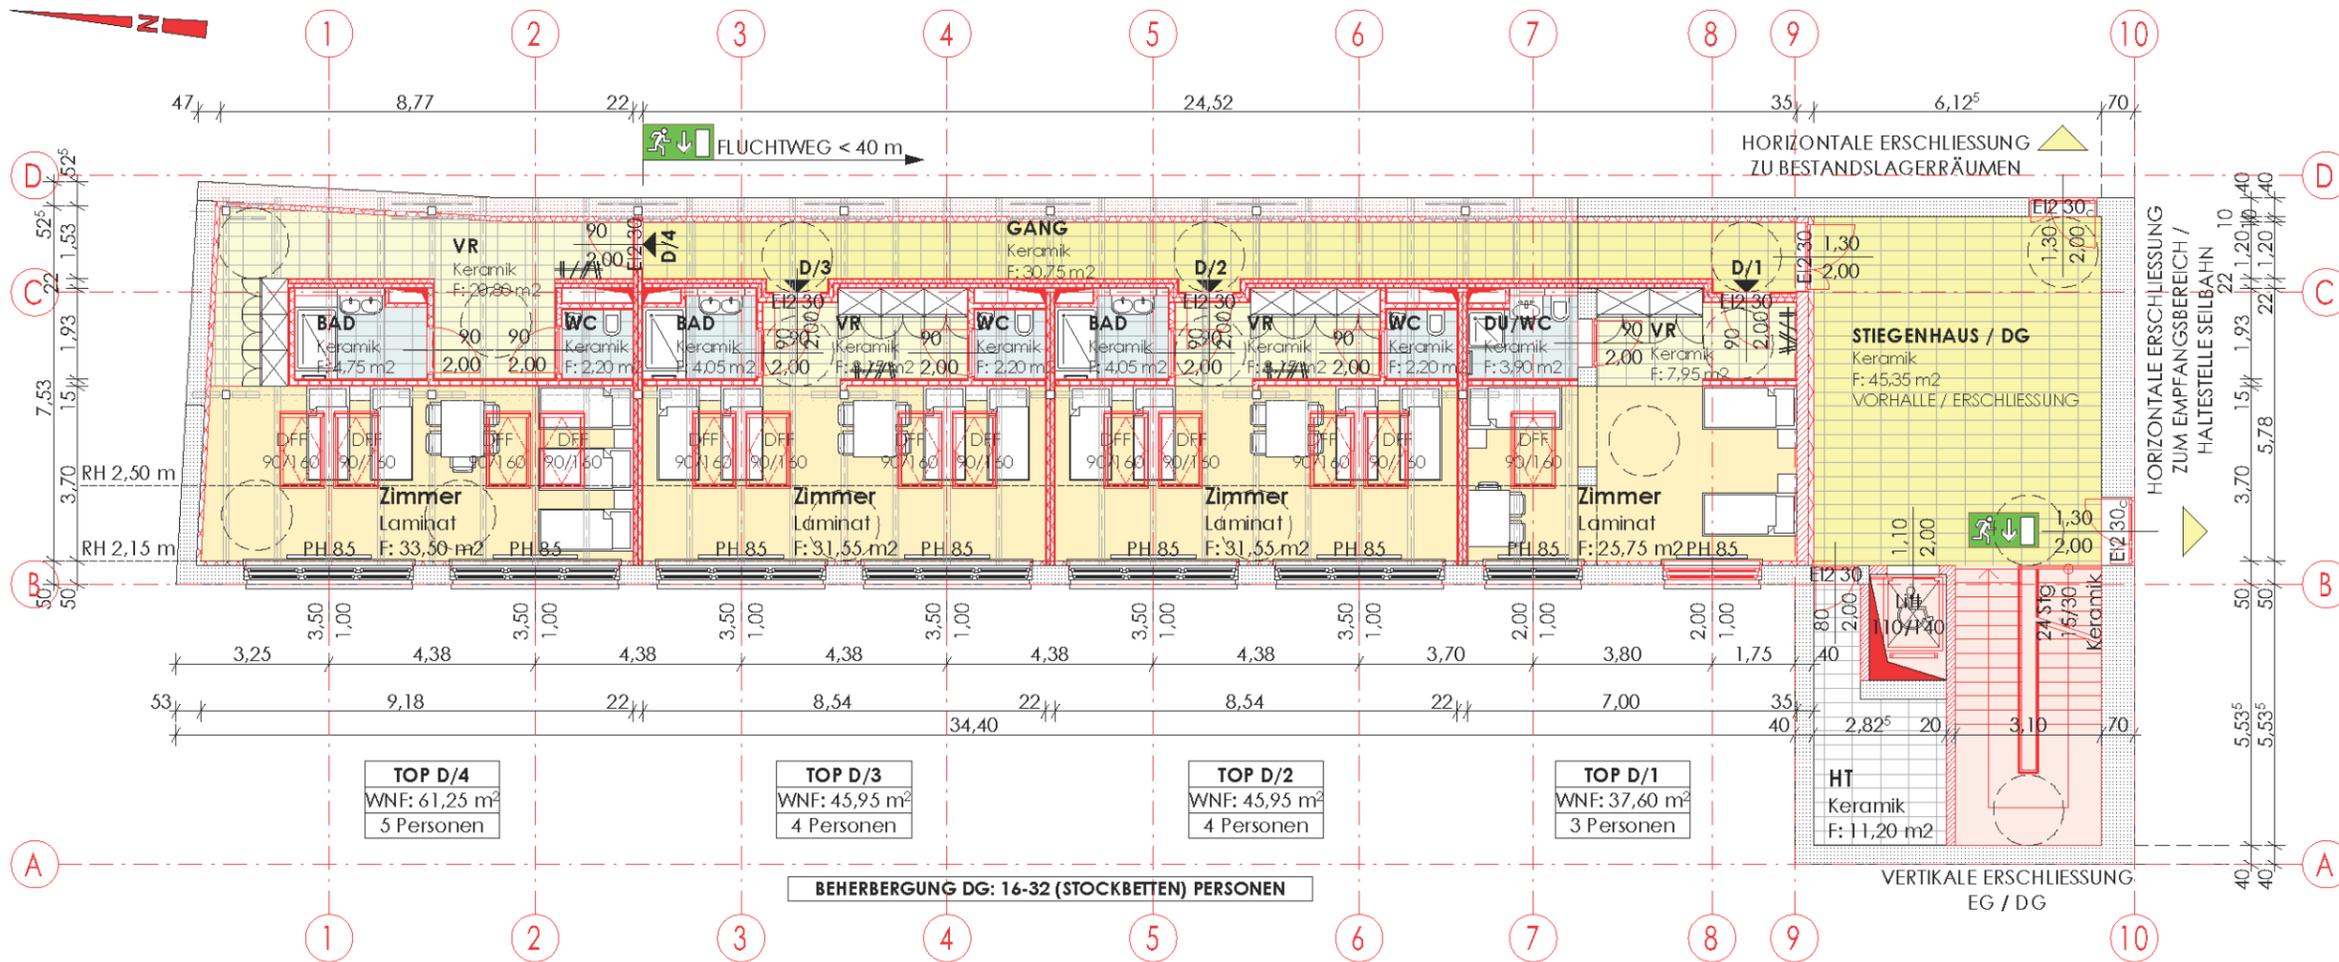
Grundriss Beherbergung DG / M 1:150
